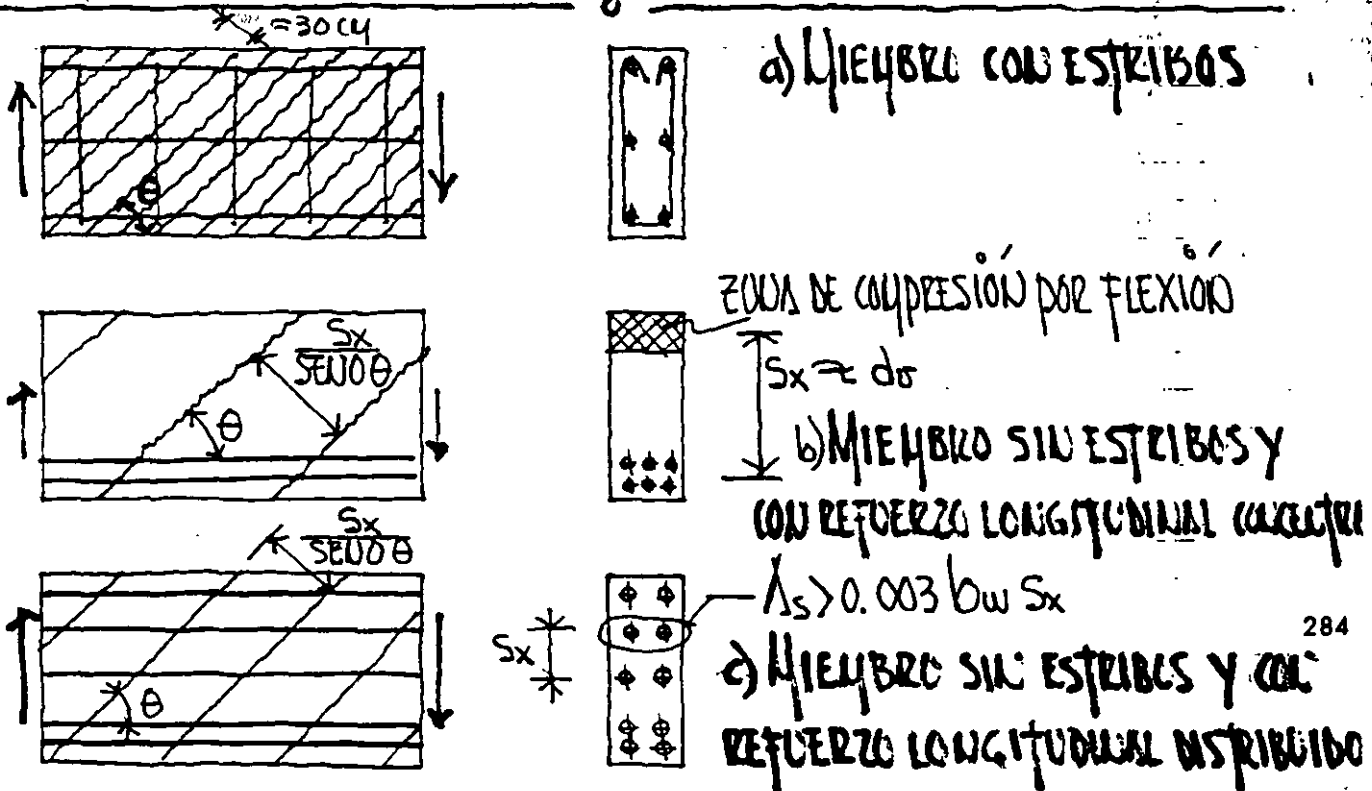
INFLUENCIA DEL REFUERZO SOBRE EL ESPACIAMIENTO DE GRIETAS
